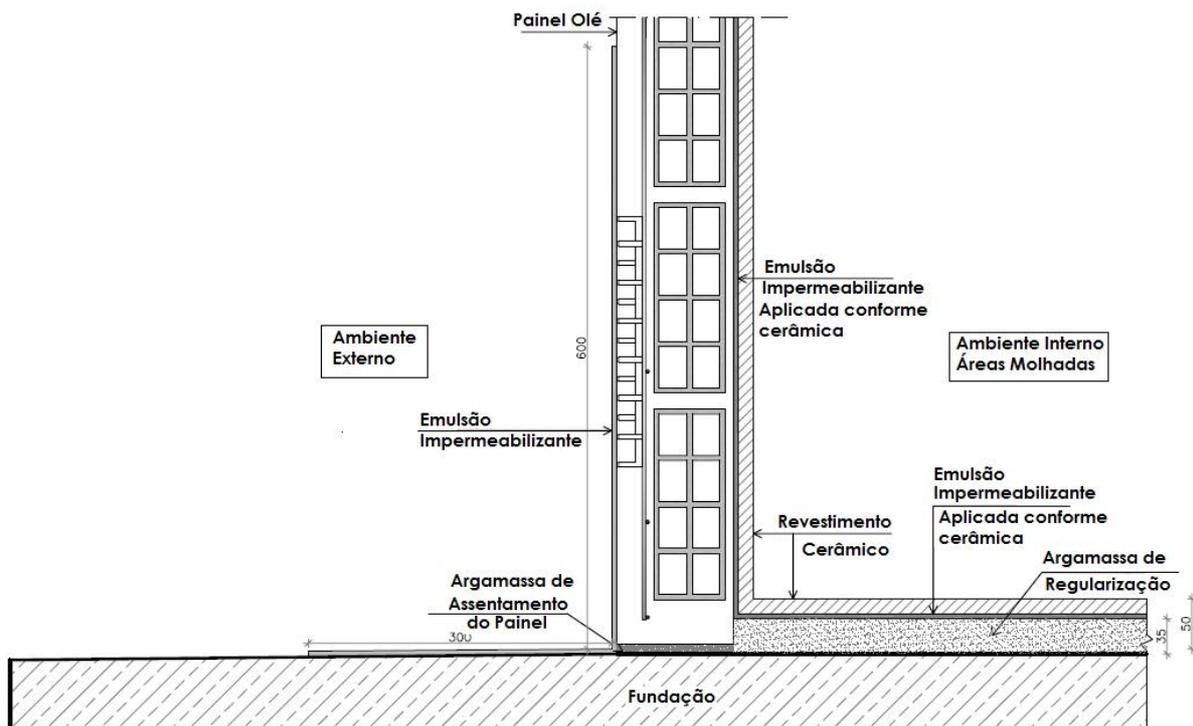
Detalhe da interface entre o painel e do piso (mm).
